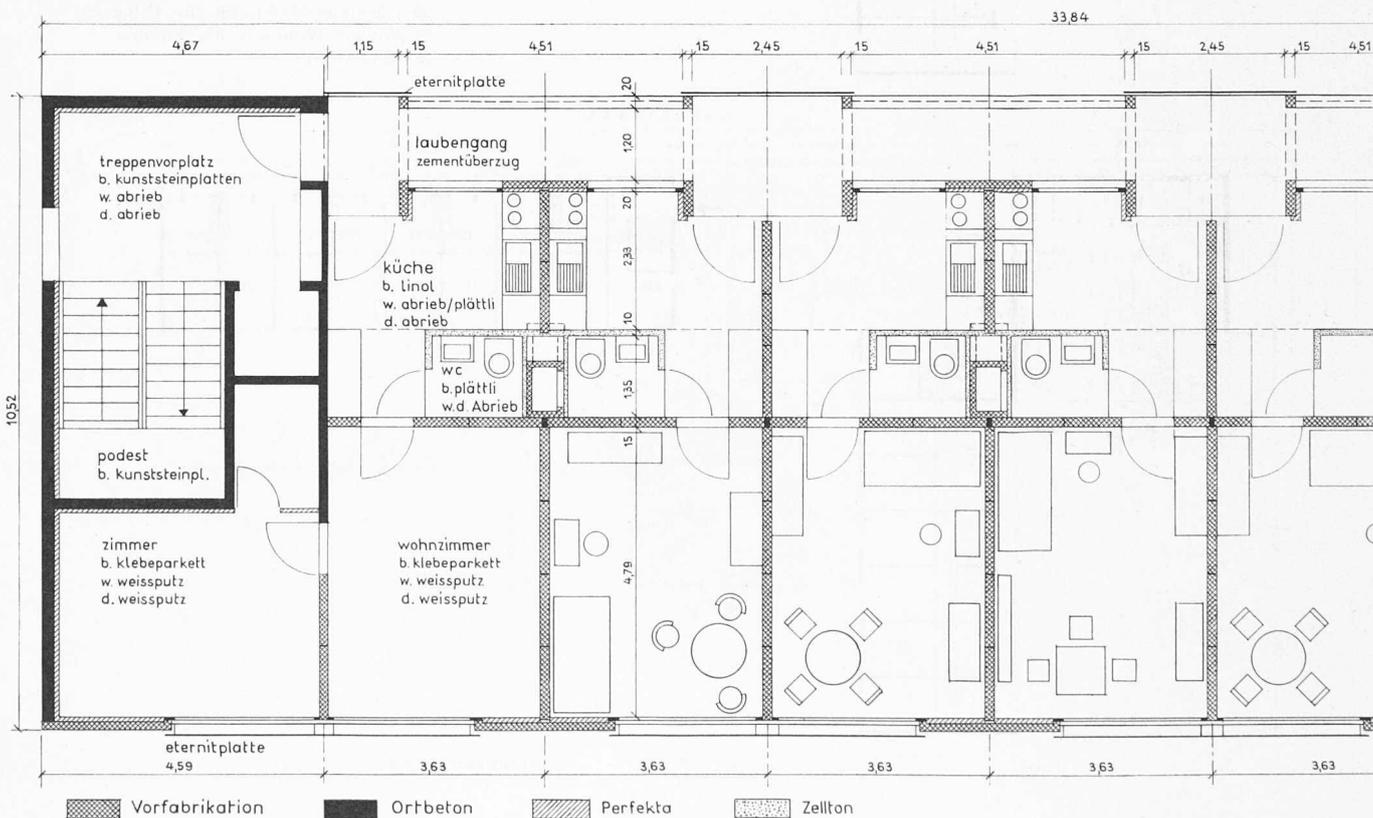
Normalgeschoss (viergeschossiger Block) 1:125 mit Angabe der Konstruktionselemente
